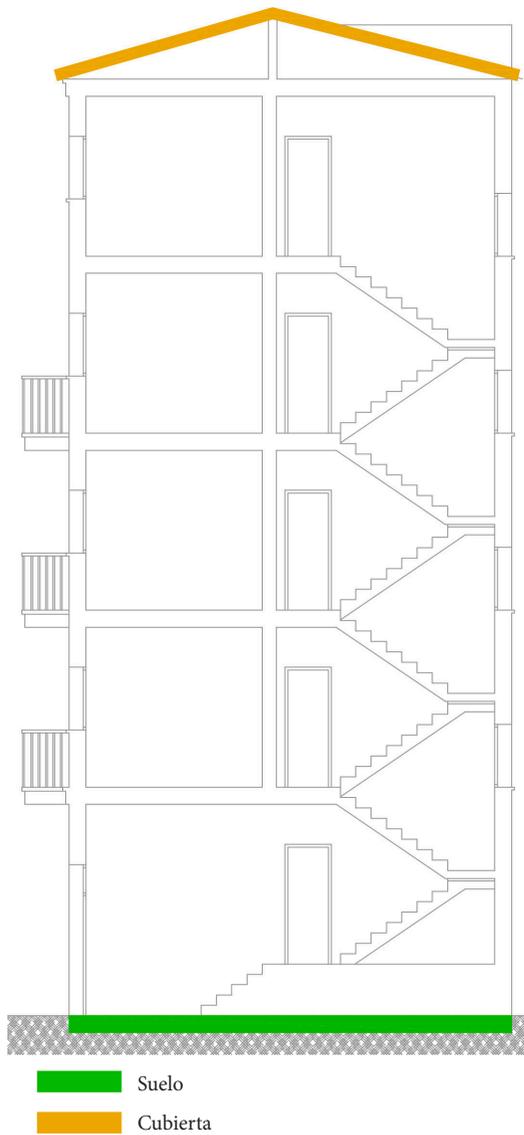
Caracterización cubierta y suelo en sección. Fuente: Elaboración propia.
